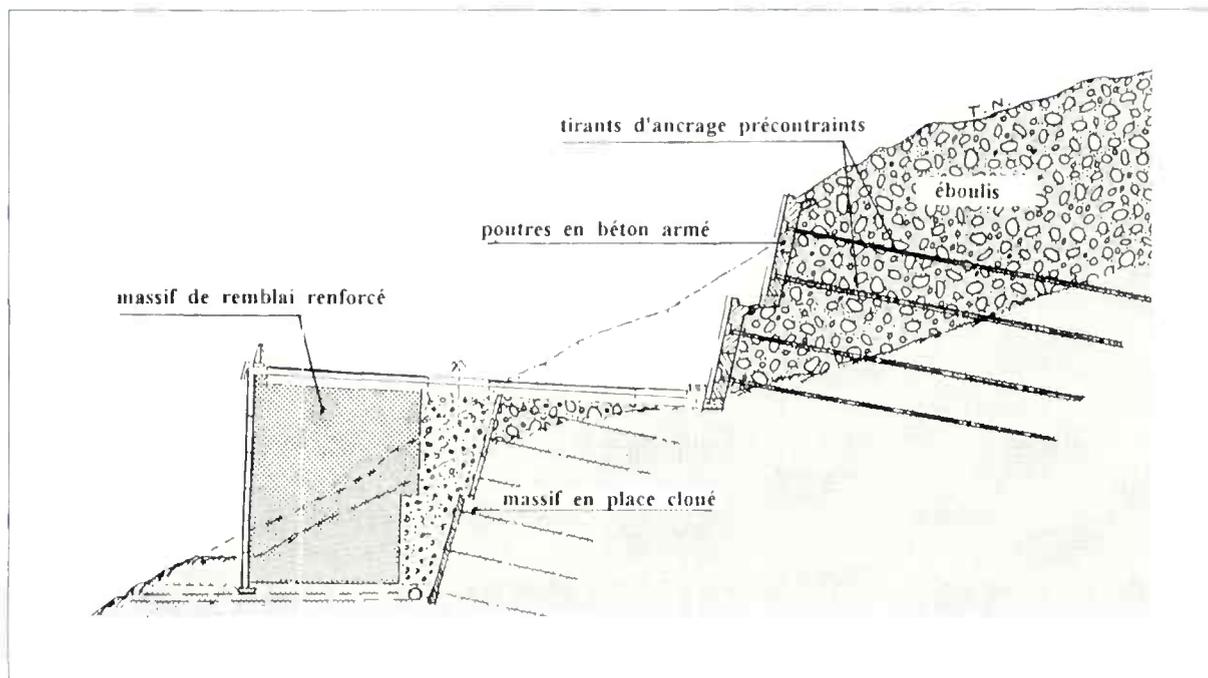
Coupe d'ouvrages de soutènement sur versant
